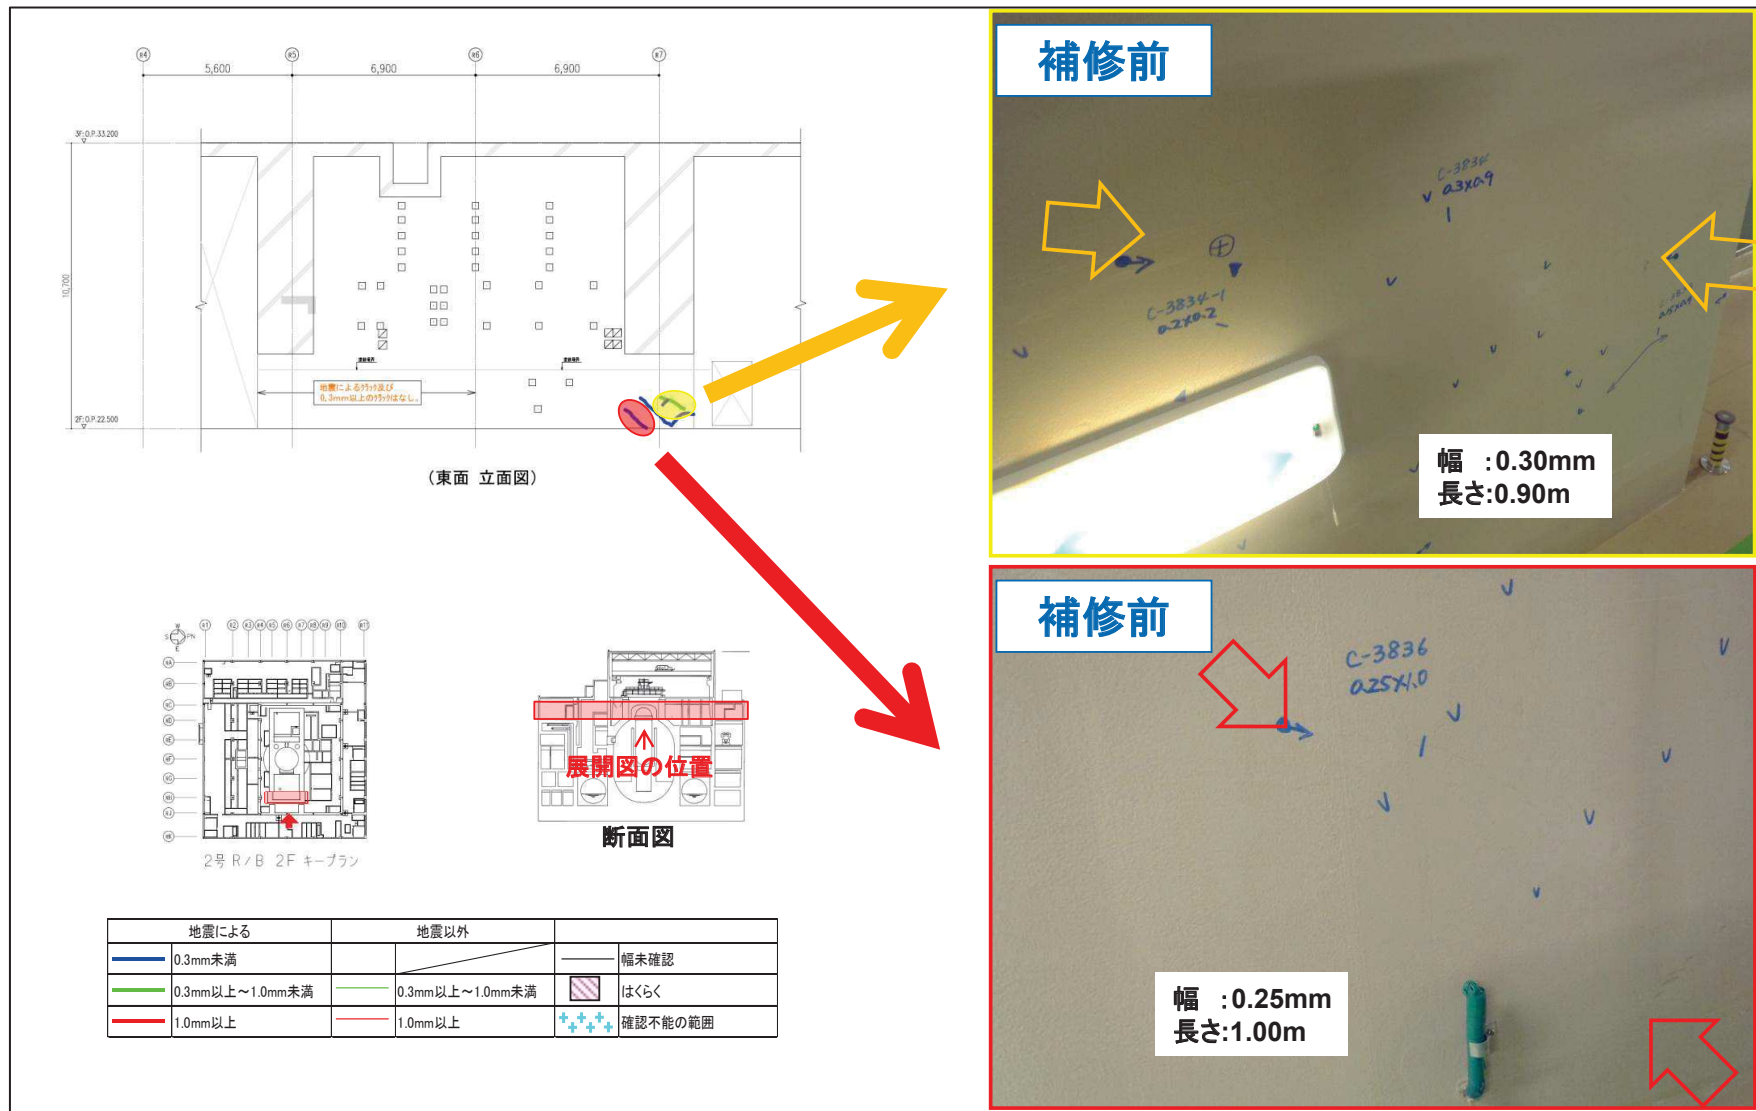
鉄筋コンクリート躯体のひび割れの例 (原子炉建屋地上 2 階)
